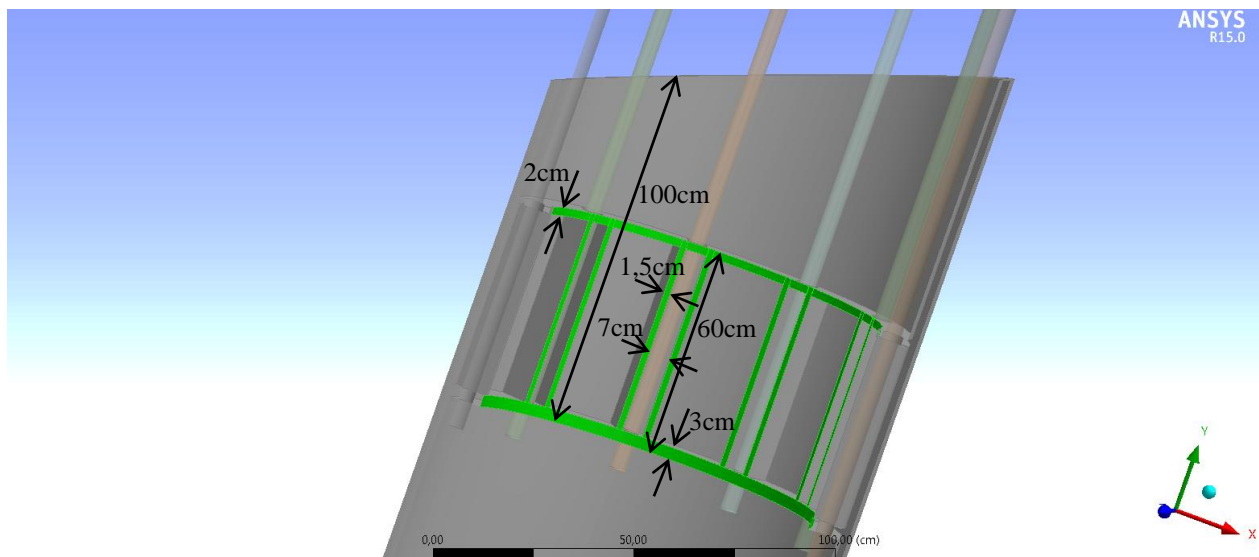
Dimensiones del sistema de anclaje para barras al pilote (vista interior del pilote).
